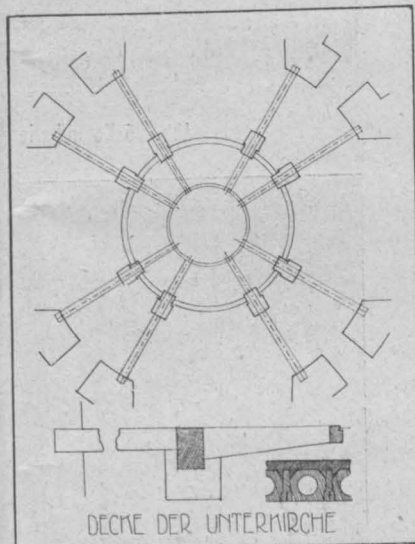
Eisenbetondecke der Unterkirche (Schema)
